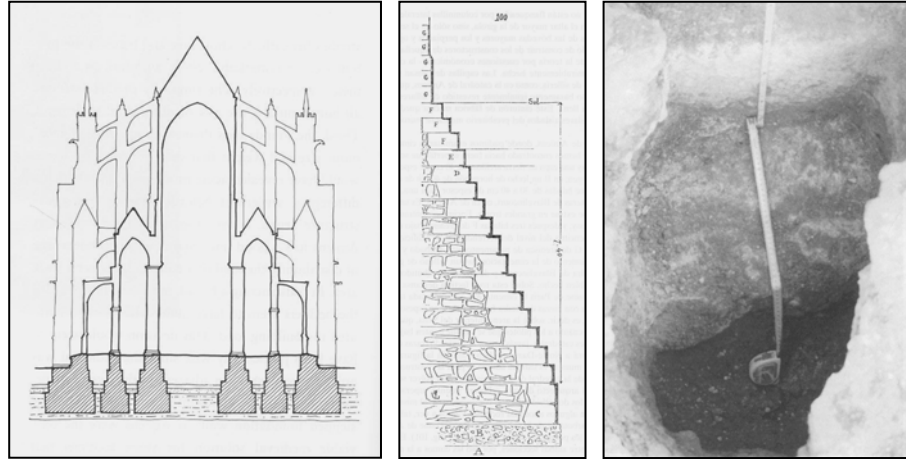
a) Sección de Beauvais (Chami) mostrando la cimentación. b) Sección de la cimentación de un estribo en Amiens (Violet le Duc). c) Fotografía de una cata de la cimentación de un estribo de Palma de Mallorca
